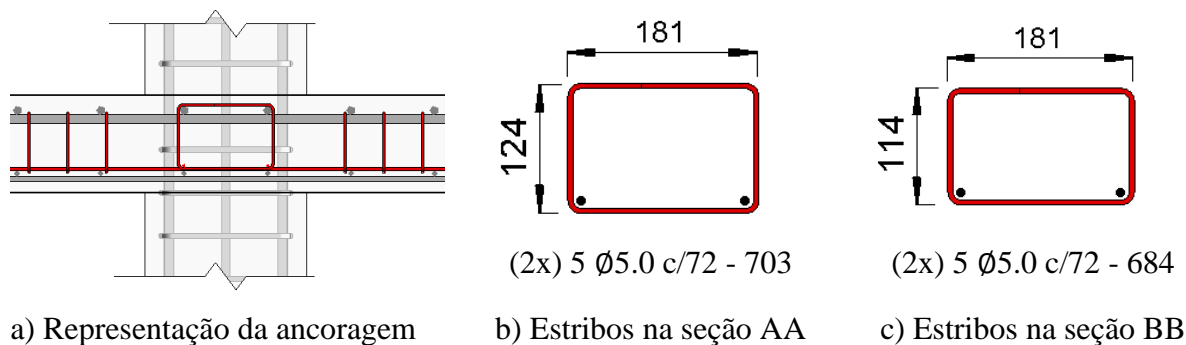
Detalhamento dos estribos da laje TA-05 (unidades em mm)
